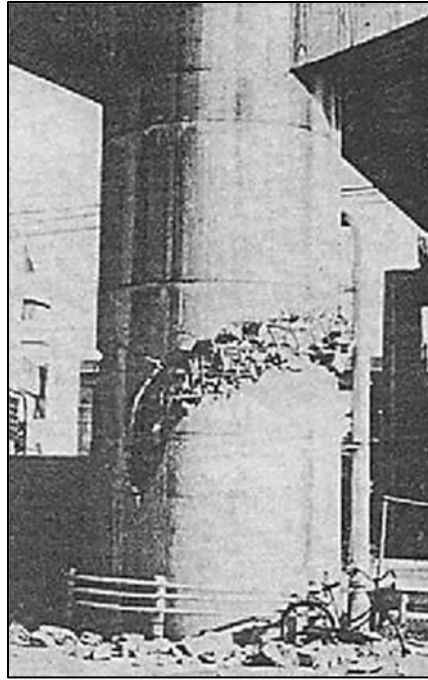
Falla por corte en las columnas donde se interrumpieron las barras verticales de refuerzo. (Fuente: Park et al., 1995, p. 61)
